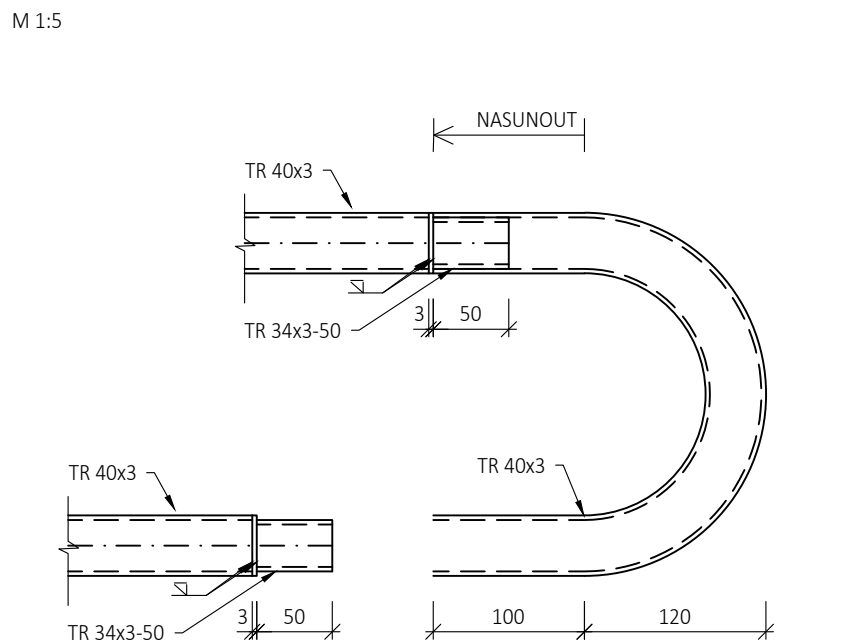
DETAIL J - ŠROUBOVANÝ PŘÍPOJ MADLA
